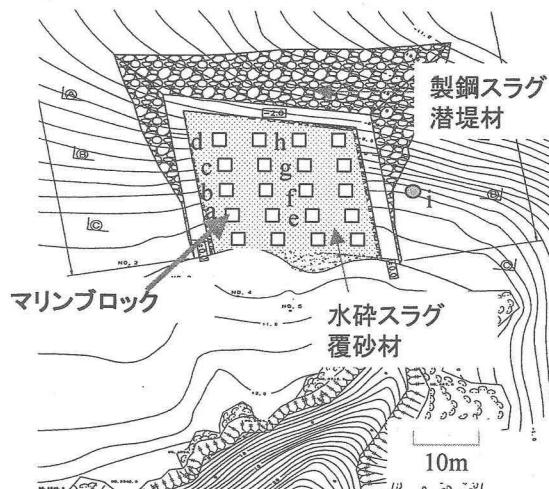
鉄鋼スラグによる浅場モデルの計画平面図
